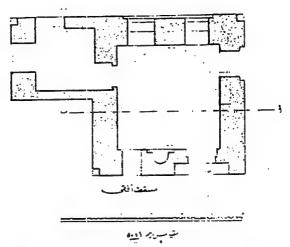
مسقط أفقى لقبة الغوري عن كلر
